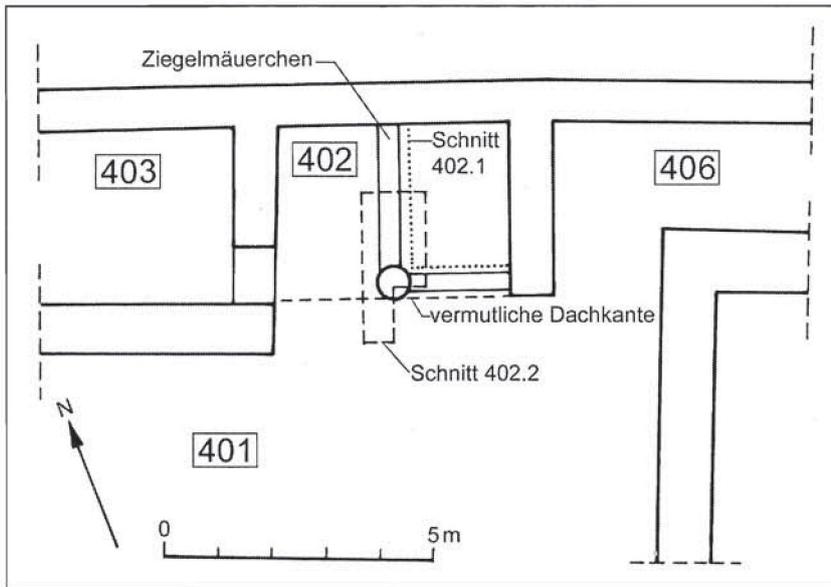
Grundriss Raum 402 mit der neuentdeckten Säule (Entwurf: D. Eigner - Zeichnung: I. Sänberlich).
